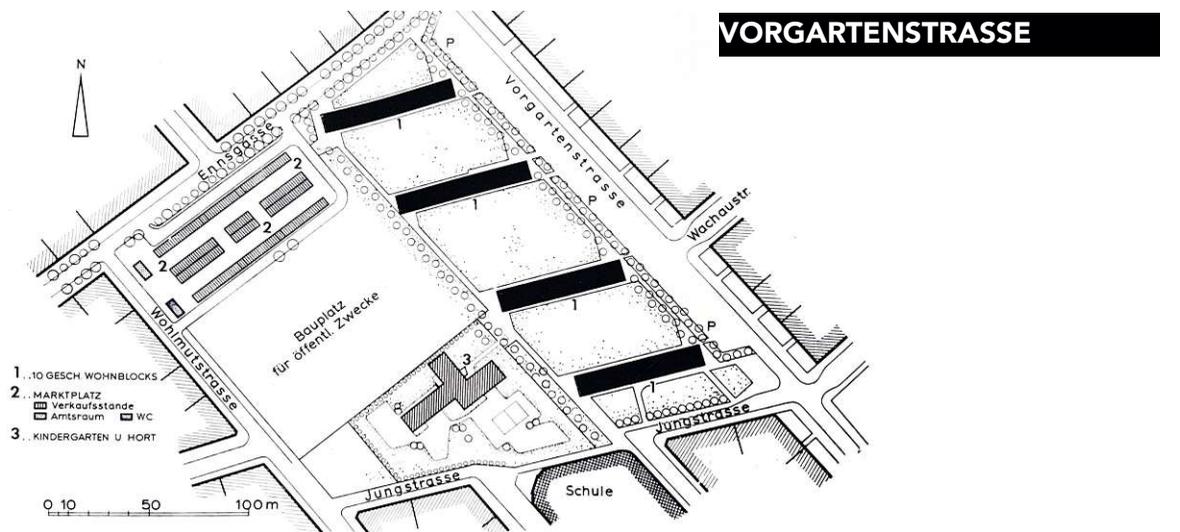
Wohnbau Vorgartenstr., Wien 2. Bezirk, 1959
